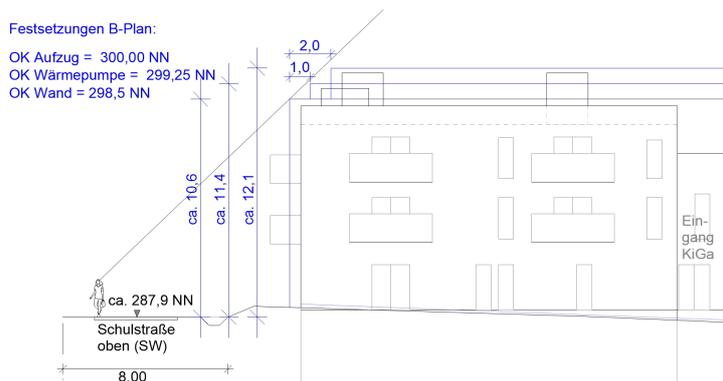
Ansicht zur Höhenfestsetzung von Dachaufbauten Büro Stadt und Natur
